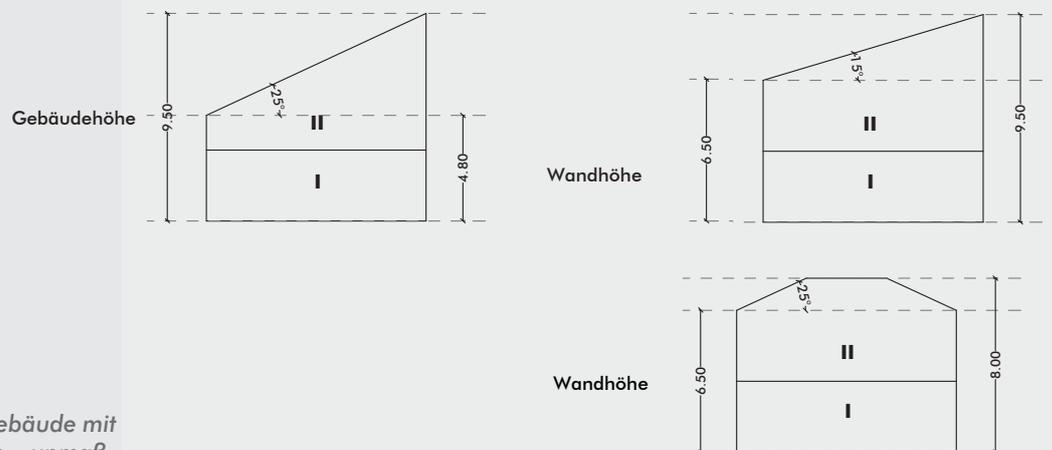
Schemaschnitt Gebäude mit Pultdach und Walmdach, unmaßstäblich
